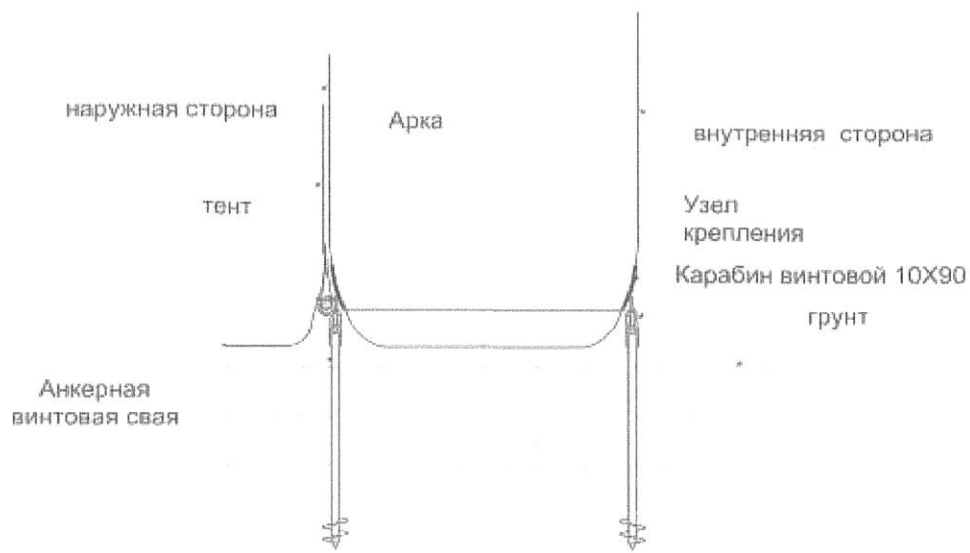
в. Схема крепления баллонов к фундаменту и натяжения накладки при помощи анкерных винтовых свай
